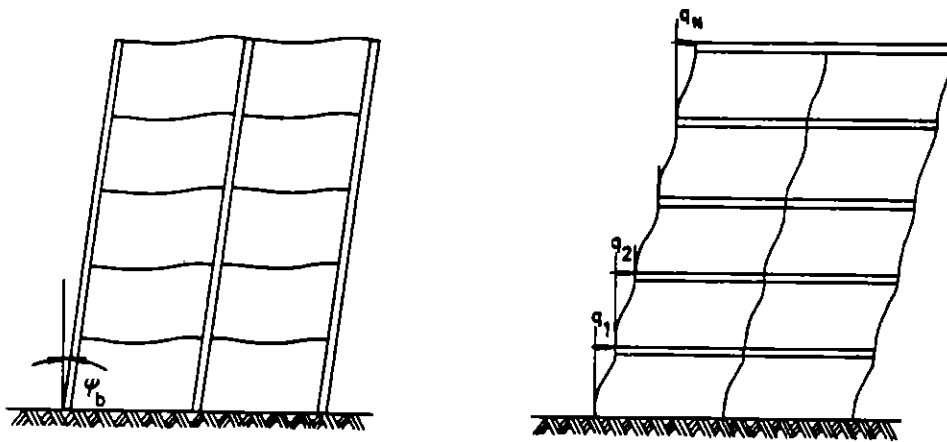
Modelos estruturais com pilares ou vigas de rigidez infinita.
